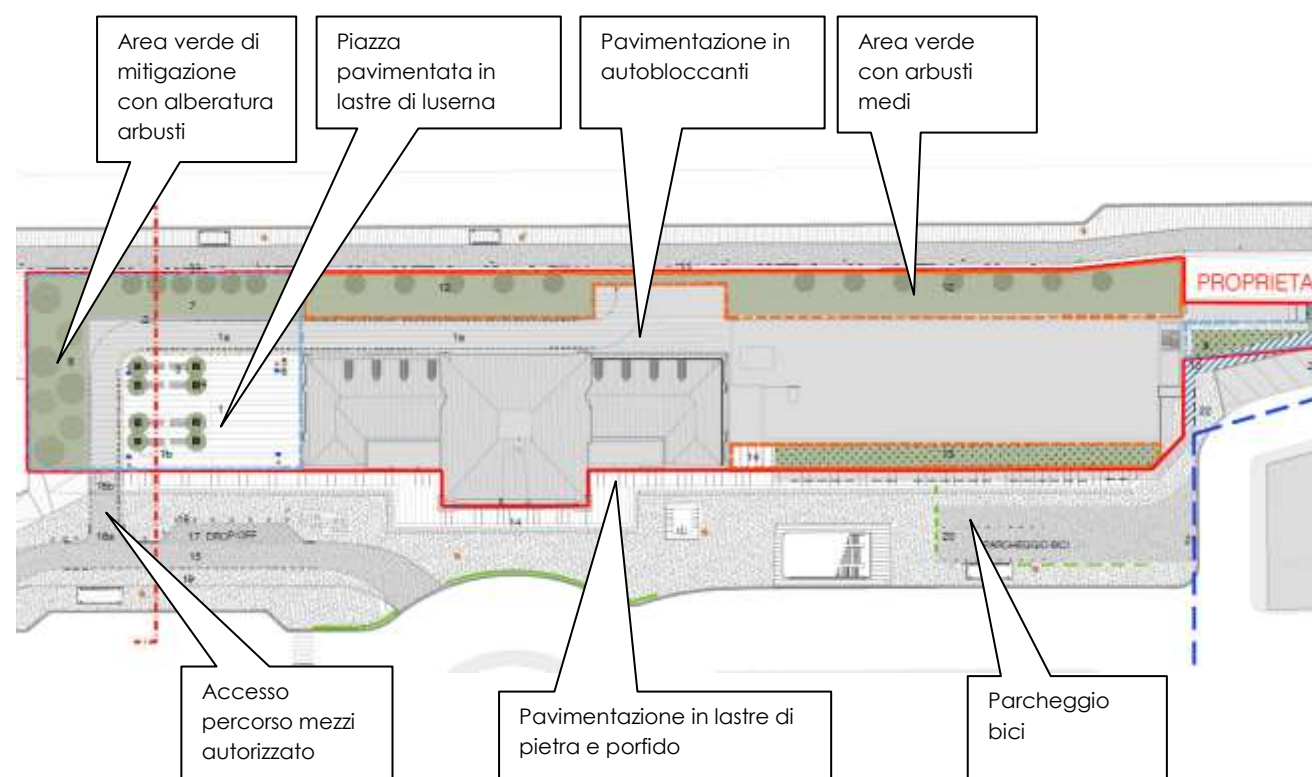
Planimetria opere di urbanizzazione e pavimentazioni
